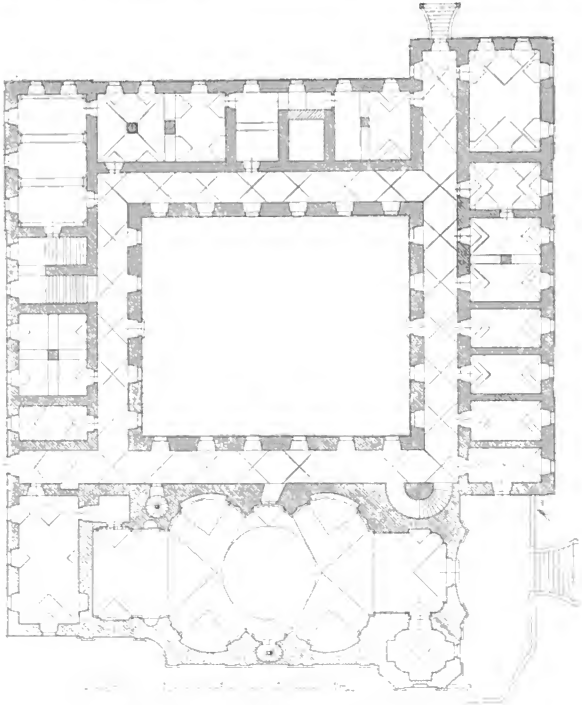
Wobolisch. Grundriss der Kirche und des Klosters.
